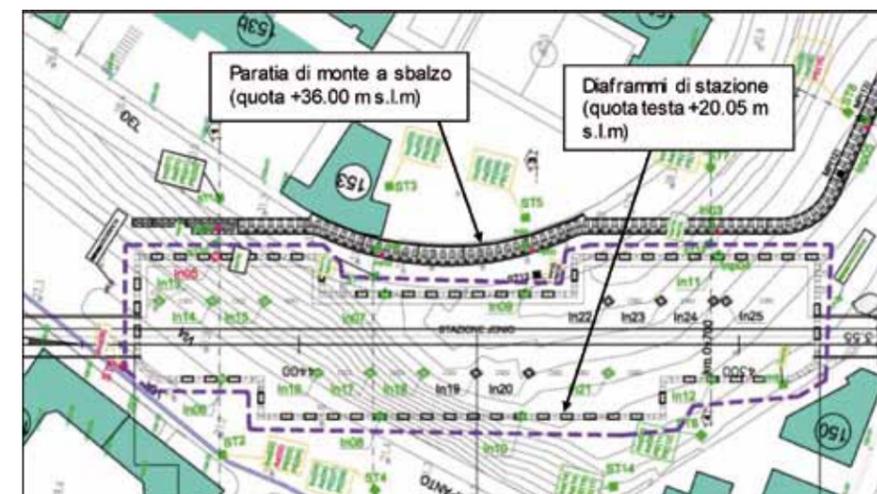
Stralcio planimetrico generale del sistema di monitoraggio
